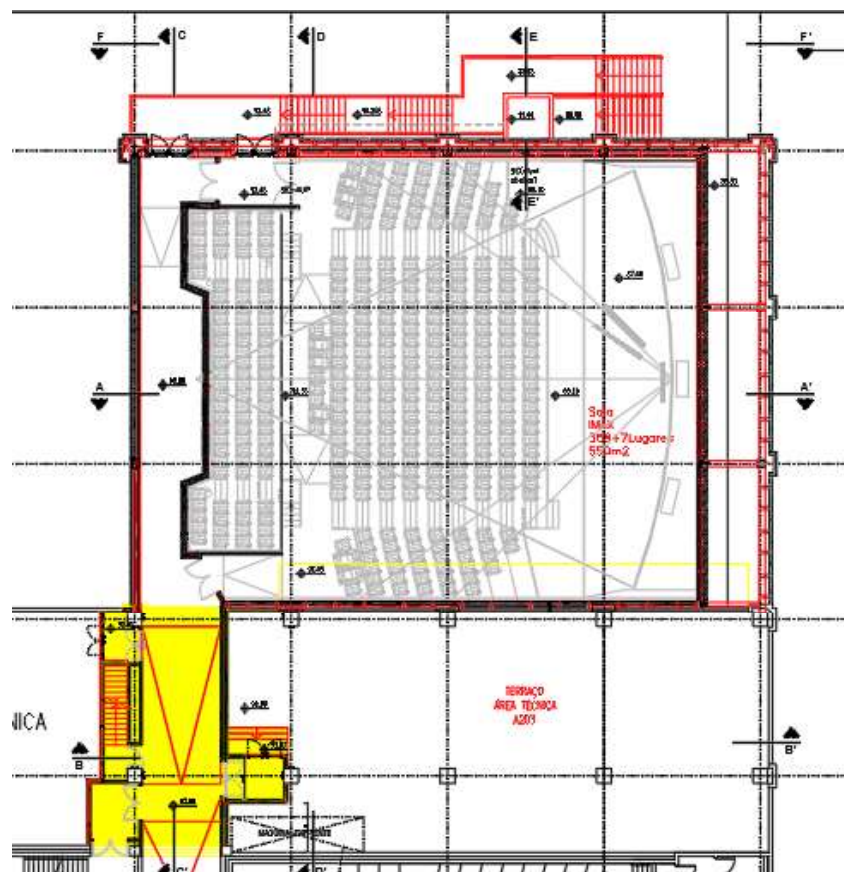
Planta baixa do piso 2 do Projeto de Arquitetura disponibilizado.
